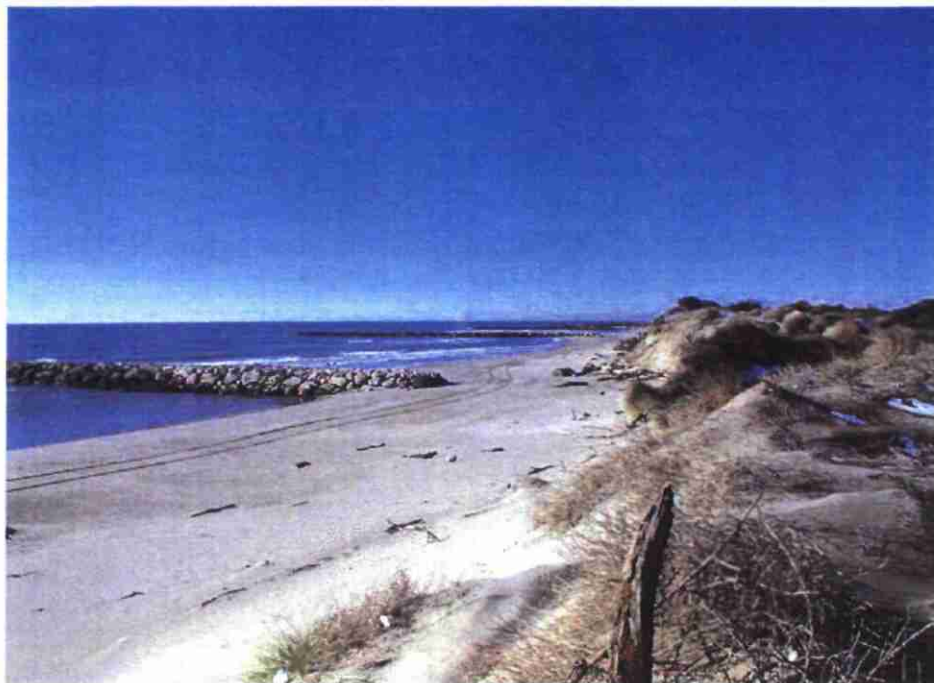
ouvrage type "épi" (n°32 au premier plan) ; à l'arrière cordon dunaire.
